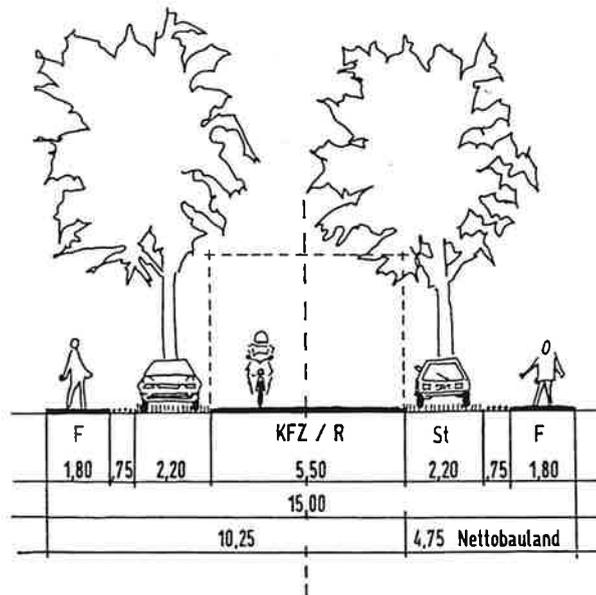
SCHNITT C-C, PLANSTRASSE C, BERTHOLDSTRASSE, PLANSTRASSE E,
